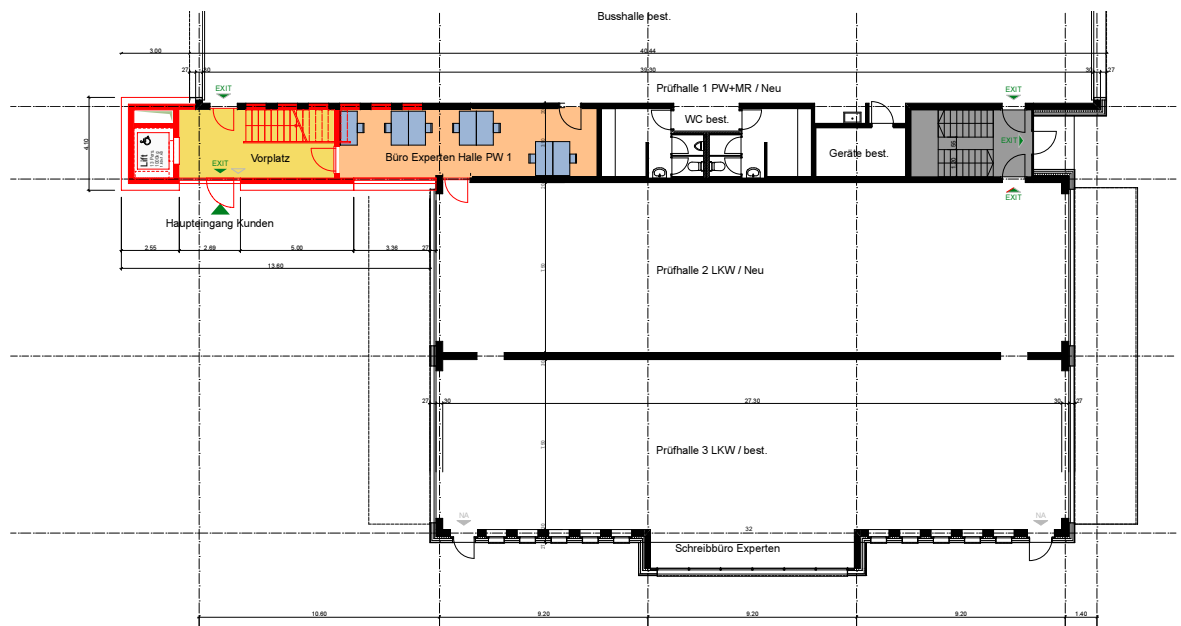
Aufstockung TO 4, MFK Verwaltung; Grundrisslayout, Erdgeschoss
